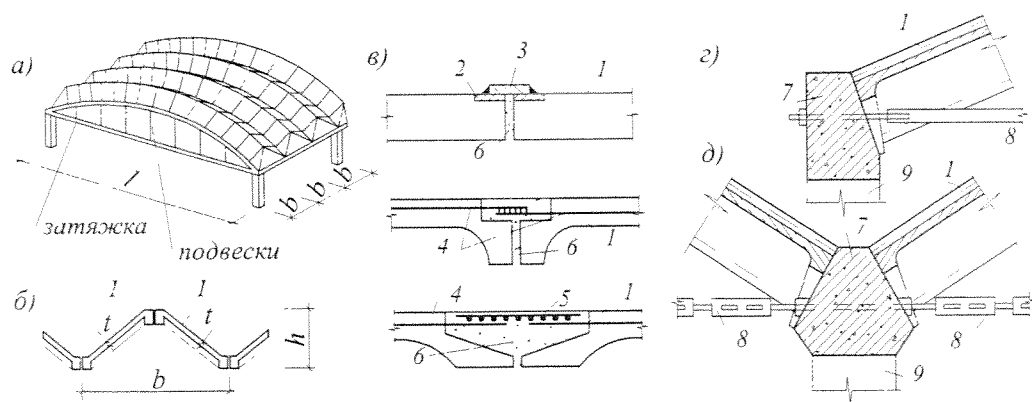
Сборный железобетонный складчатый свод треугольного профиля:
